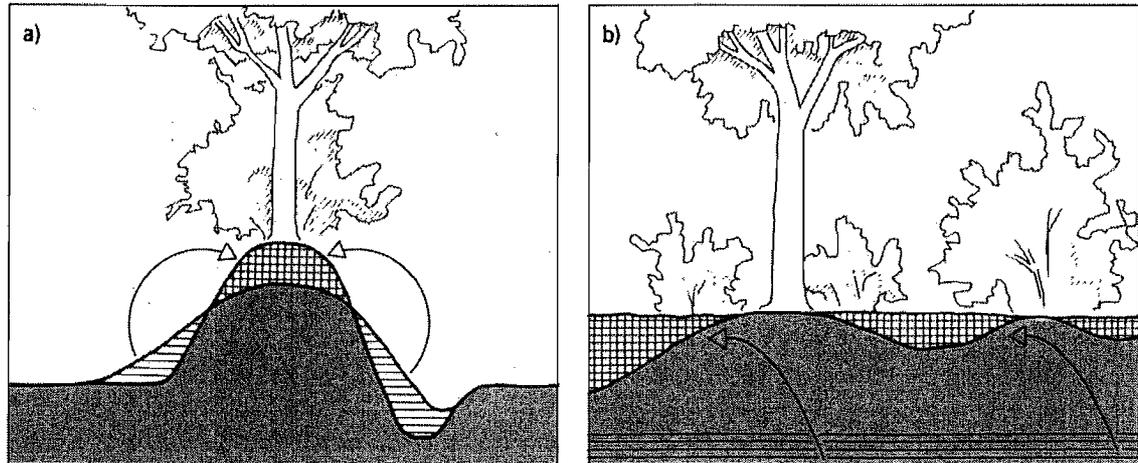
Instandsetzen eines Walkörpers a) Querschnitt, b) Seitenansicht
